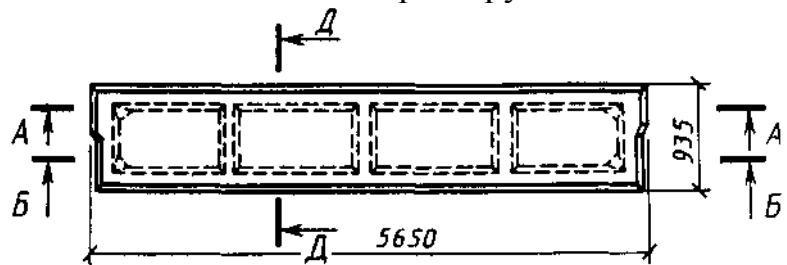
Загальний вигляд залізобетонних ребристих плит перекриттів
